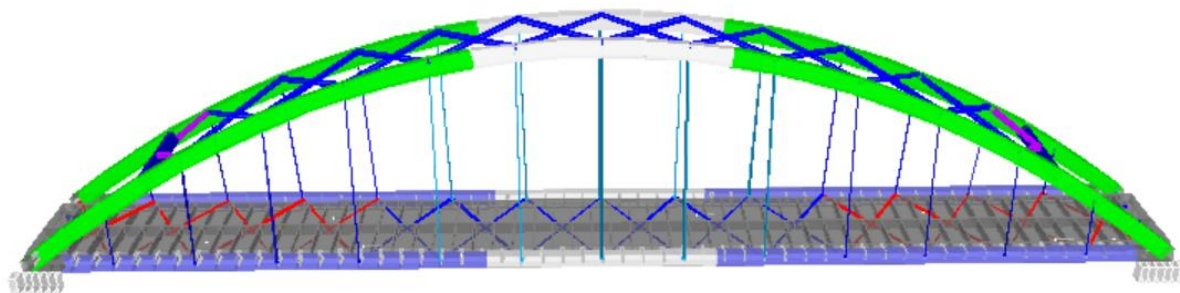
Vista 3D do modelo estrutural da ponte em arco metálico deste trabalho.
